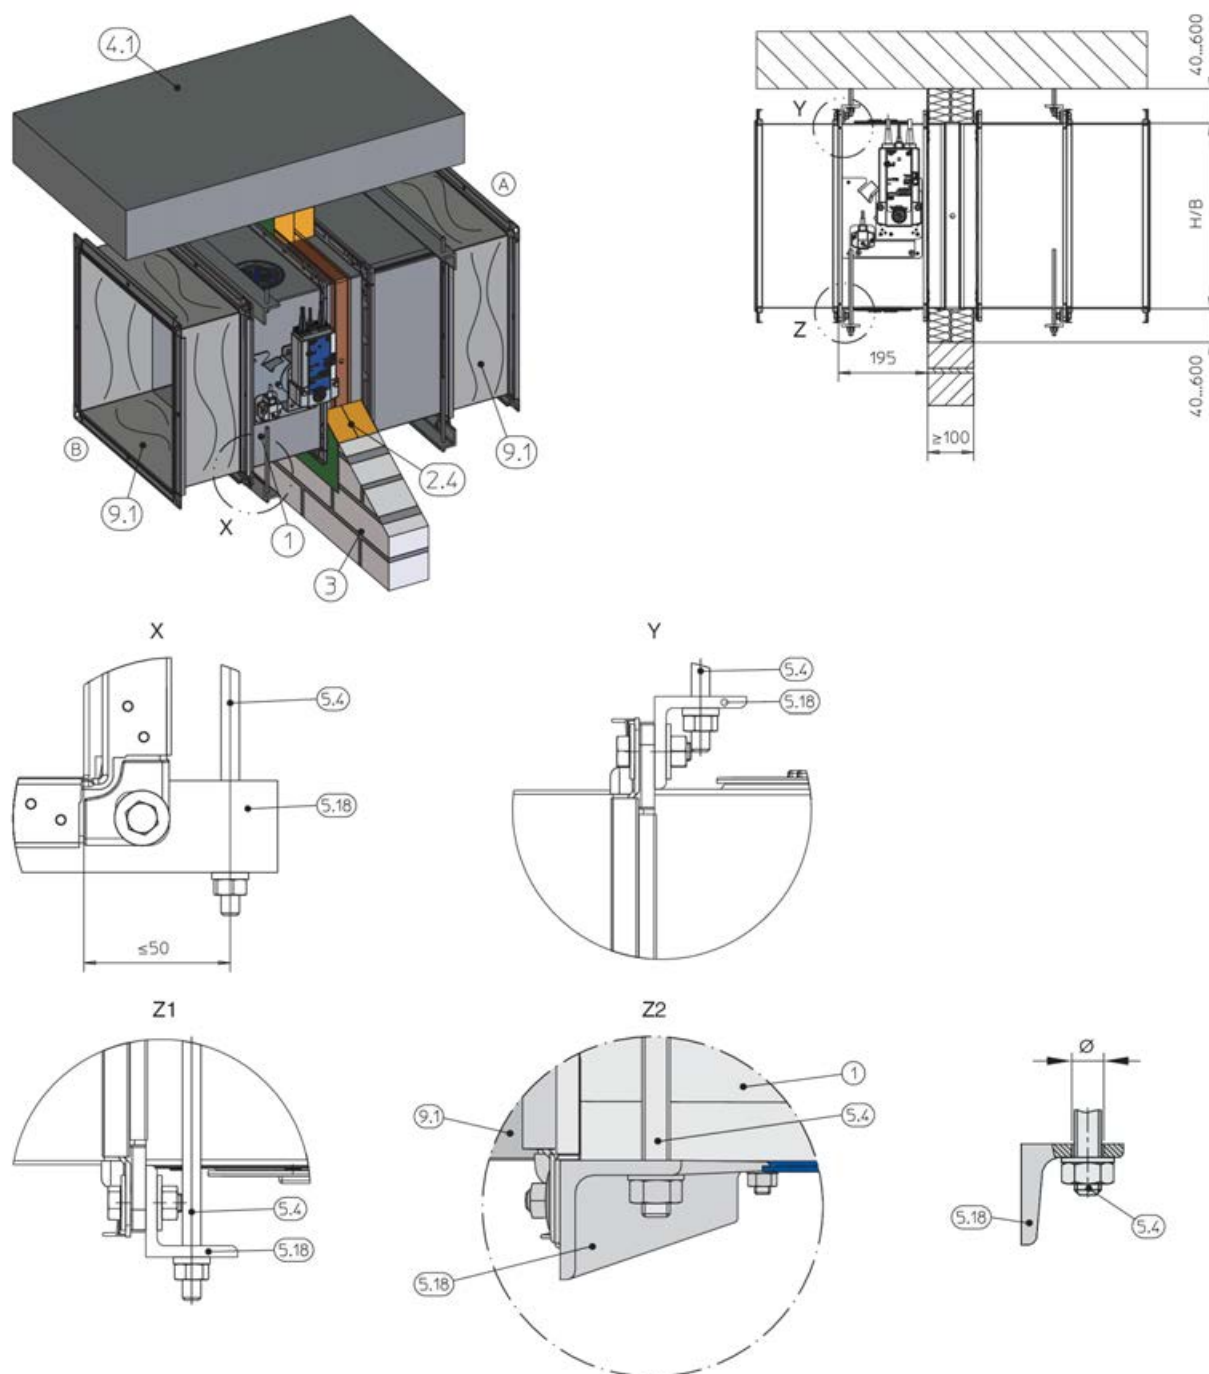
Montage à sec sans mortier avec kit d'installation WE
